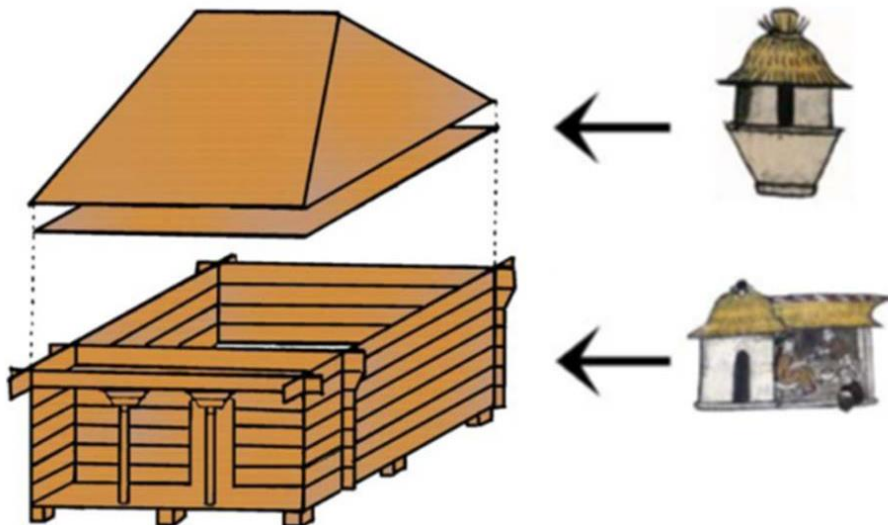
ALZADO Y PLANTA DEL TROJE.
